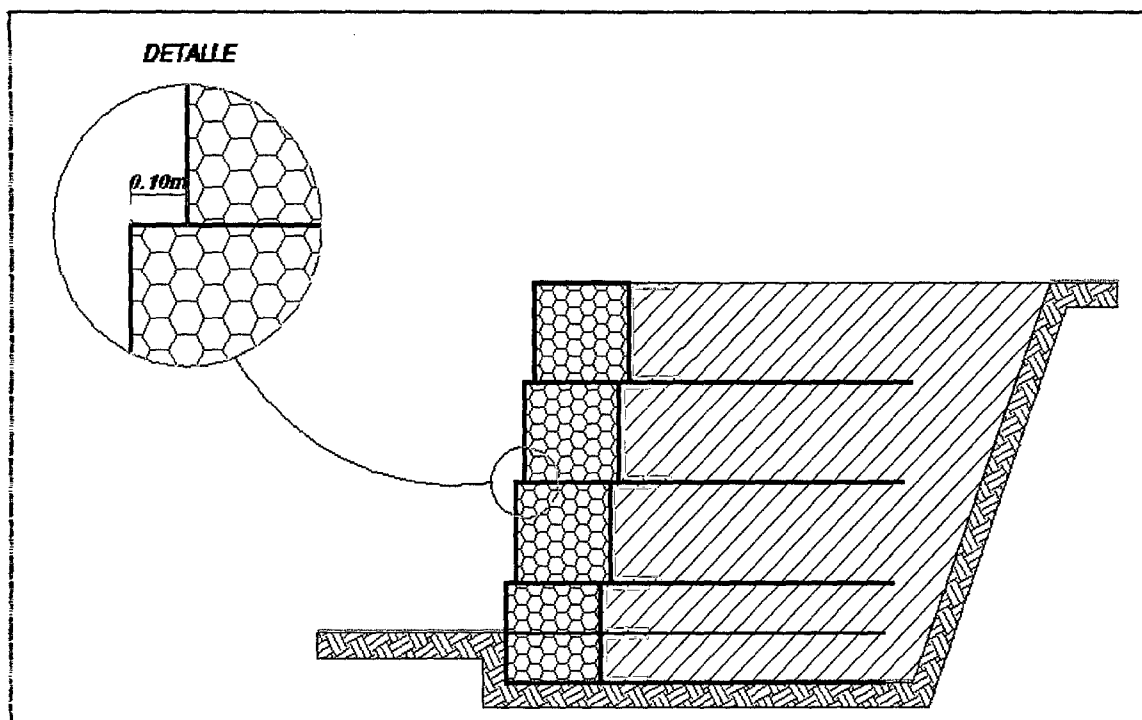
Muro de gavión-Terramesh System, vista en perspectiva
